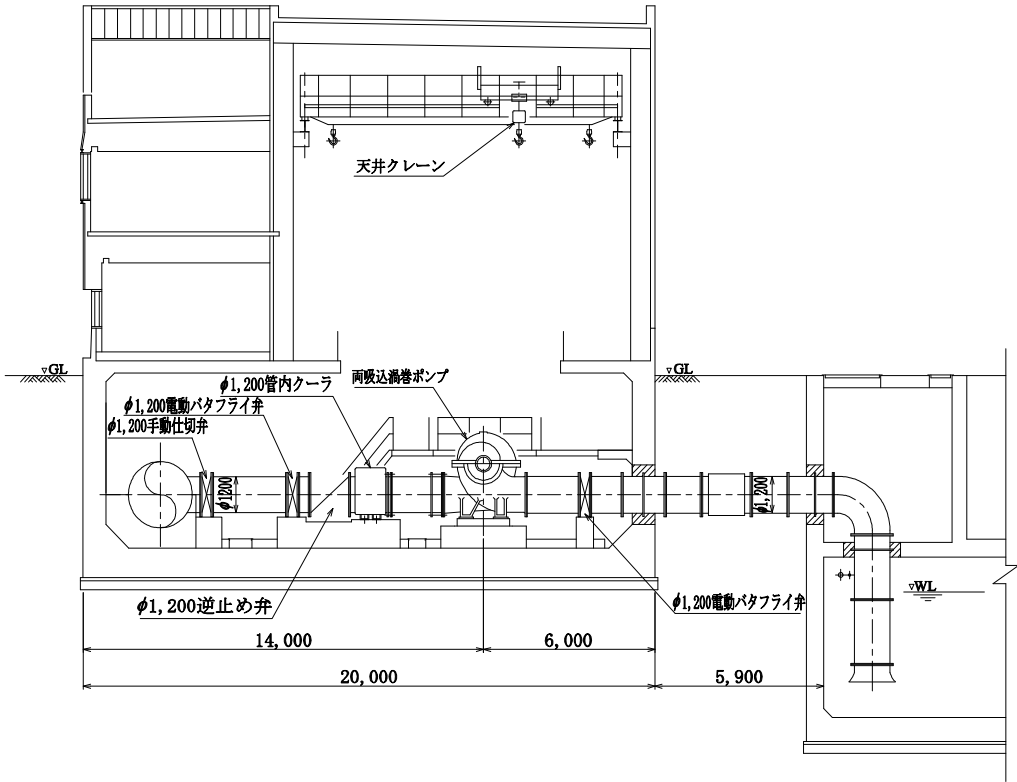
41 (a)-参 横軸両吸込渦巻ポンプ平面図 (例)
